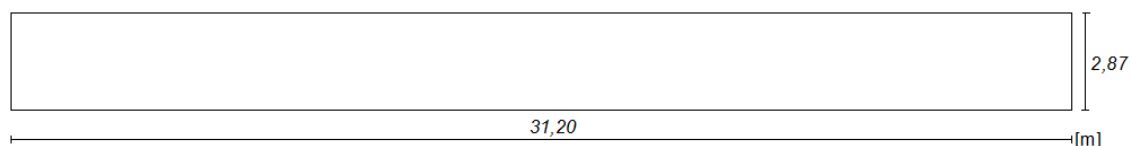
Pormenorização das lajes modeladas em planta (Marques, J. 2013)
